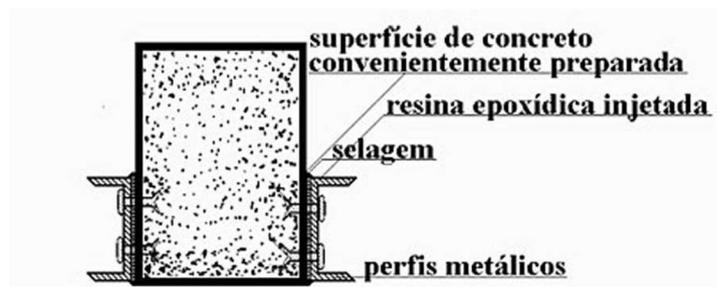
Reforço por chumbamento de perfis metálicos (RIPPER, 1998)
